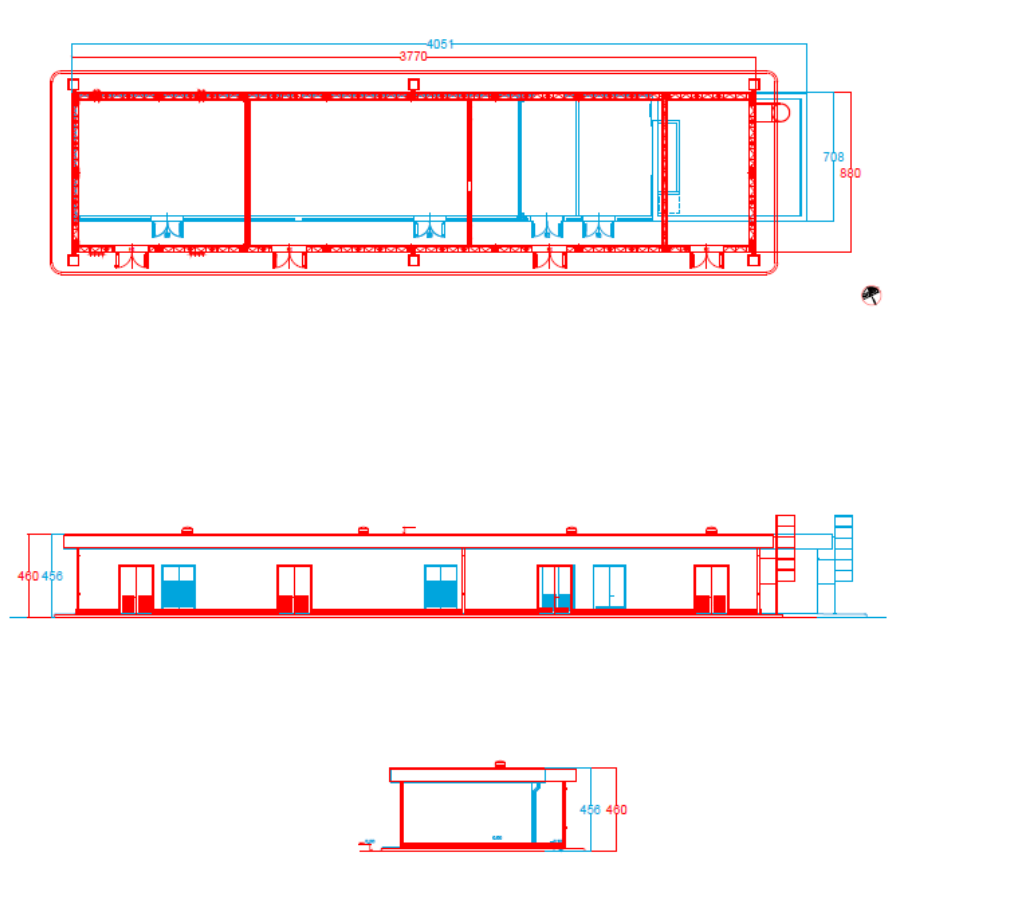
Progetto in variante – piazzale INVI - Pianta
